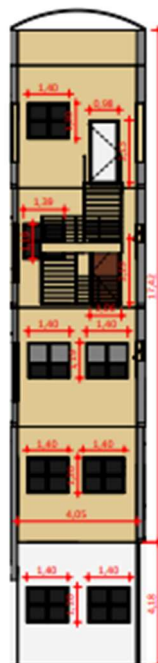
Elevação - Fosso Fundos - Vista Norte - TJMSP
